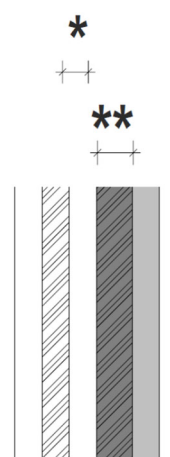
Sonderaufbauten der MHM – Wandelemente mit 5 Lagen
